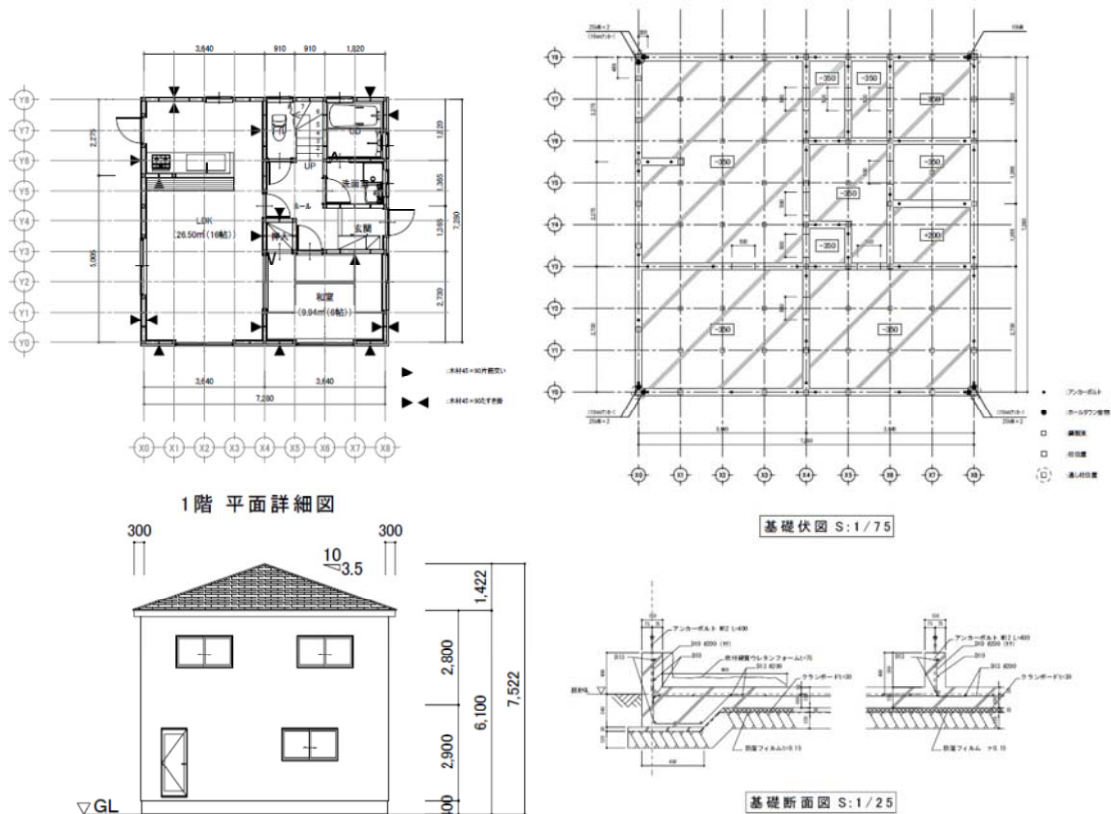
モデル家屋の平面図、立面図、基礎伏図
